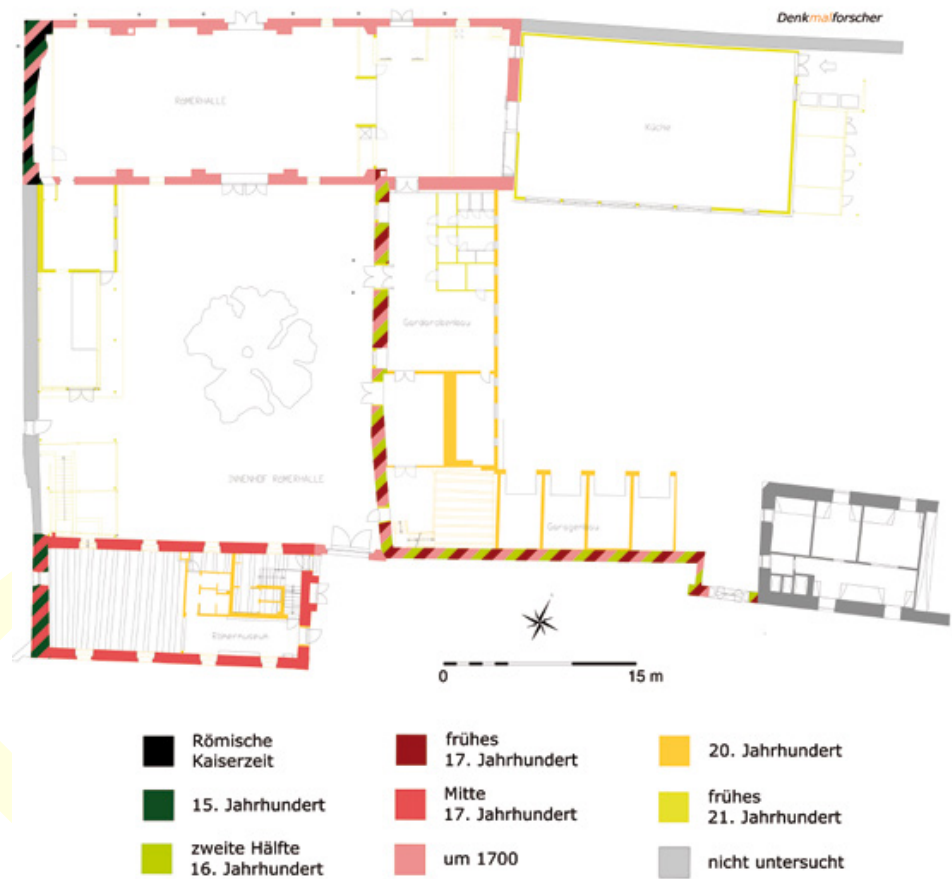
Mautern, Schloss. Baualterplan des Erdgeschoßes der Nebengebäude.
